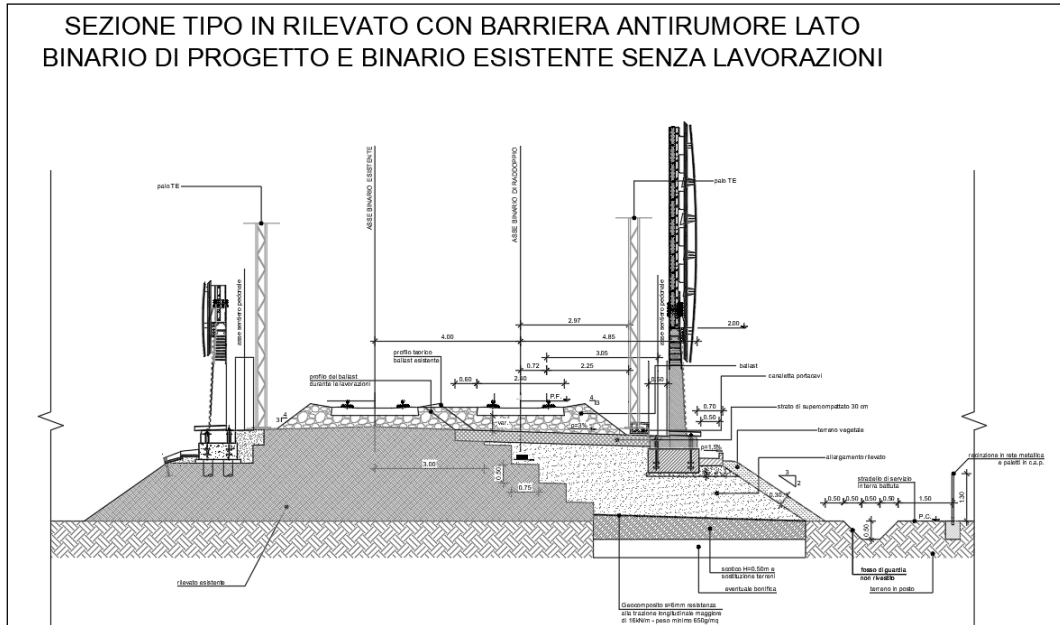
Sezione tipo in rilevato con barriera antirumore lato binario di progetto e binario esistente senza lavorazioni
